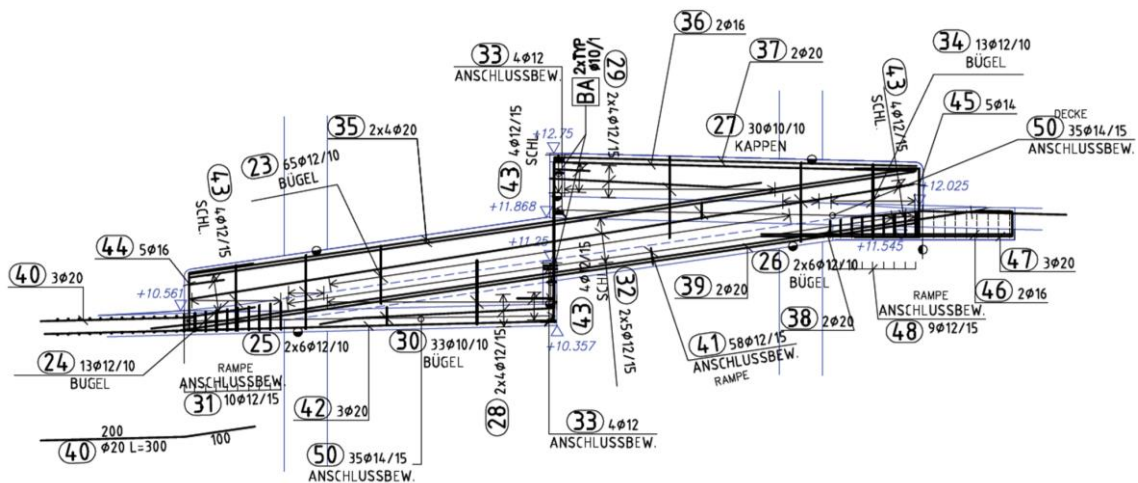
Auszug aus dem Bewehrungsplan von Rampenträgerpaar 2<sup>26</sup>
